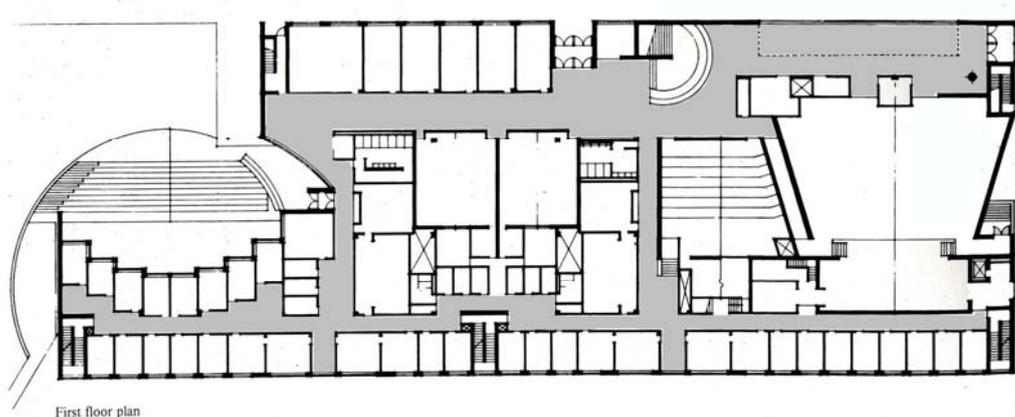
Pavilhão de Humanidades. Planta do 1º pavimento.
